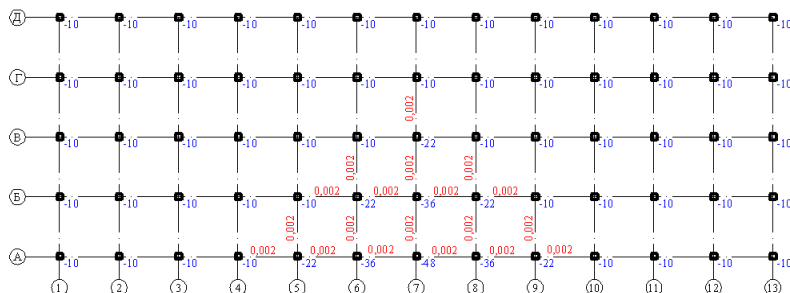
Расчетная схема здания при заданных сочетаниях осадок (осадка центральной и крайней части фундамента)
